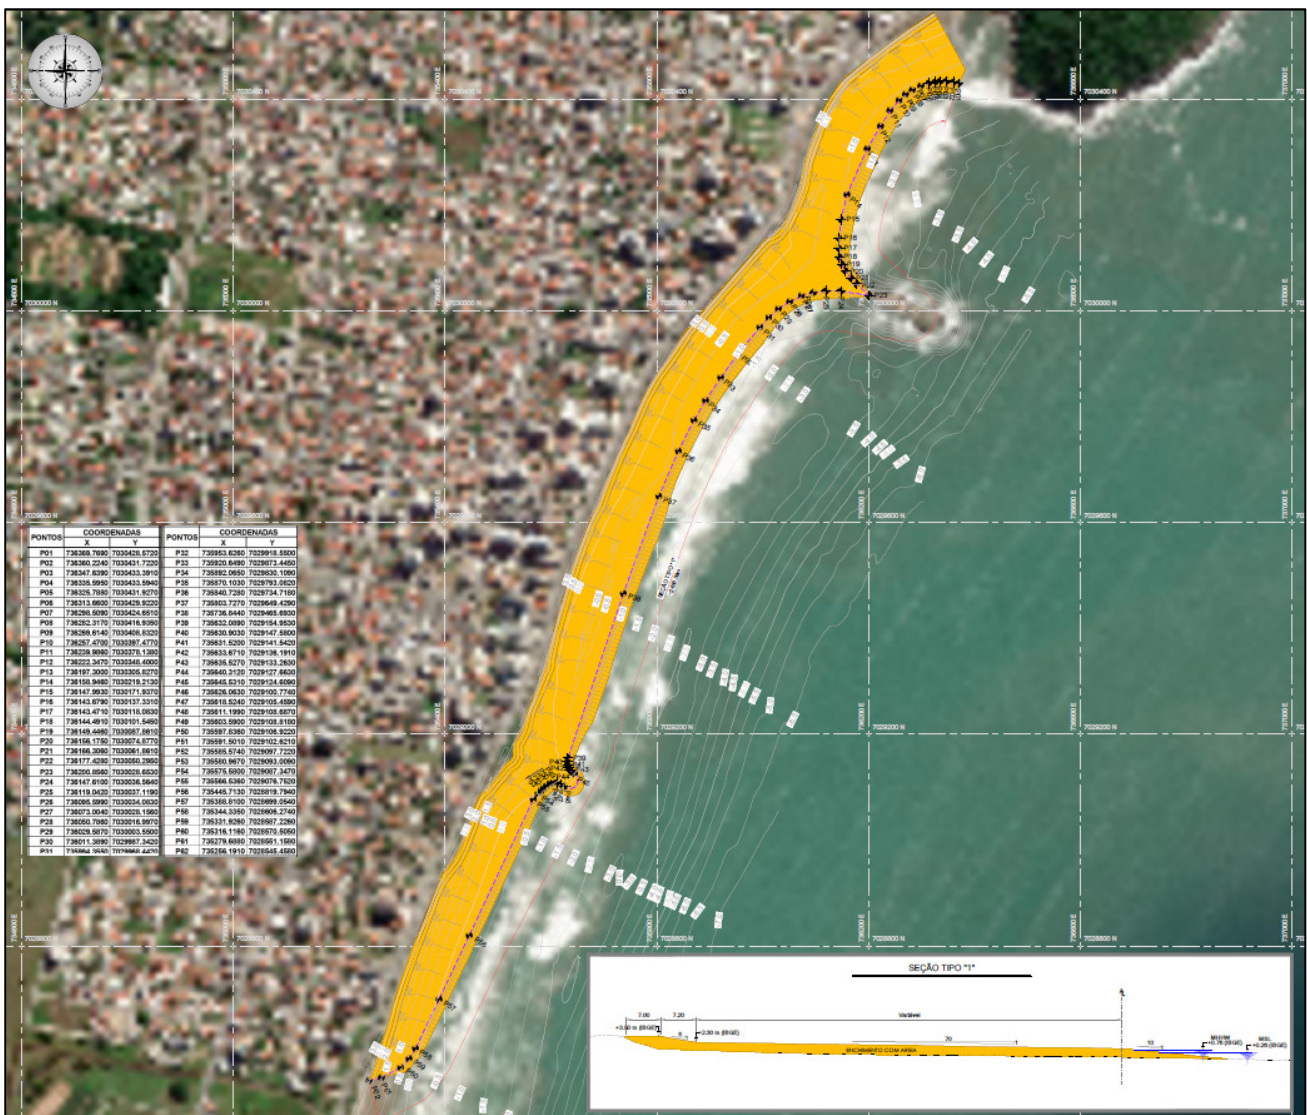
Vista geral do projeto de enchimento da Praia do Gravatá, com detalhe em uma seção tipo de construção.
